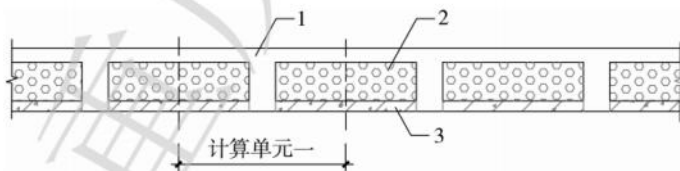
装配箱混凝土空心楼板横截面计算单元示意图
